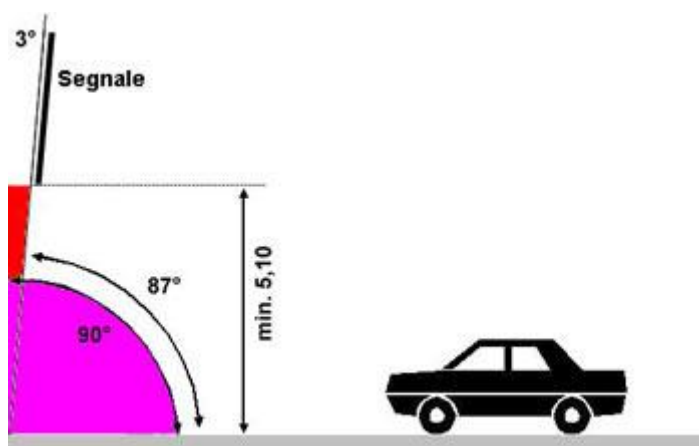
Schema di installazione segnaletica verticale su carreggiata
